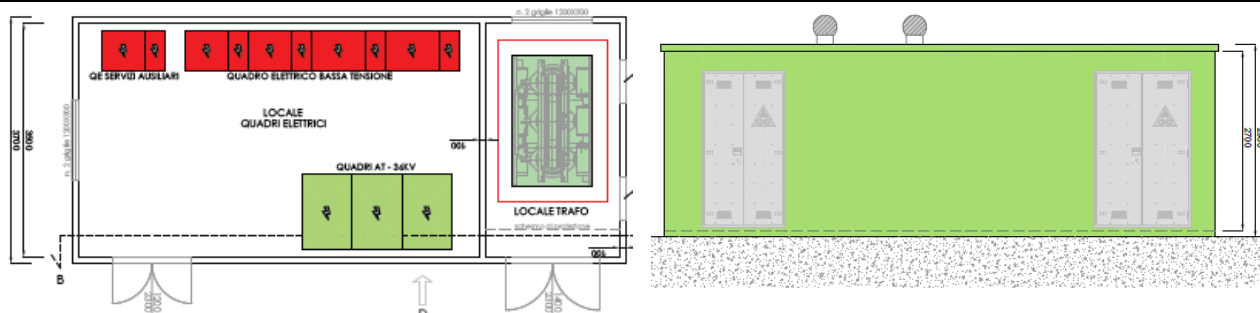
Pianta e Prospetto cabina di trasformazione
